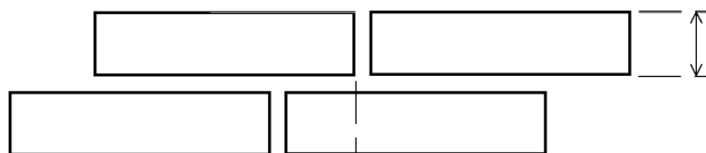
Перекриття блоків кам'яної кладки
